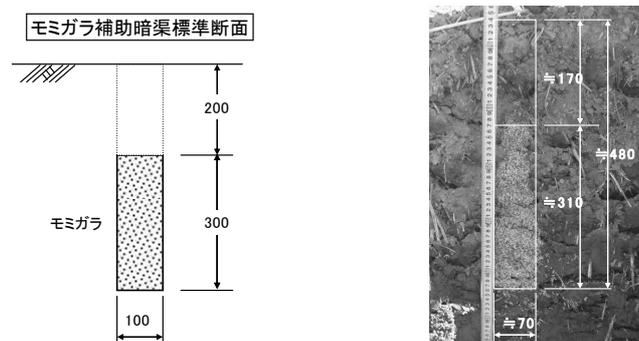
補助暗渠標準断面 写真-6 補助暗渠施工後断面
